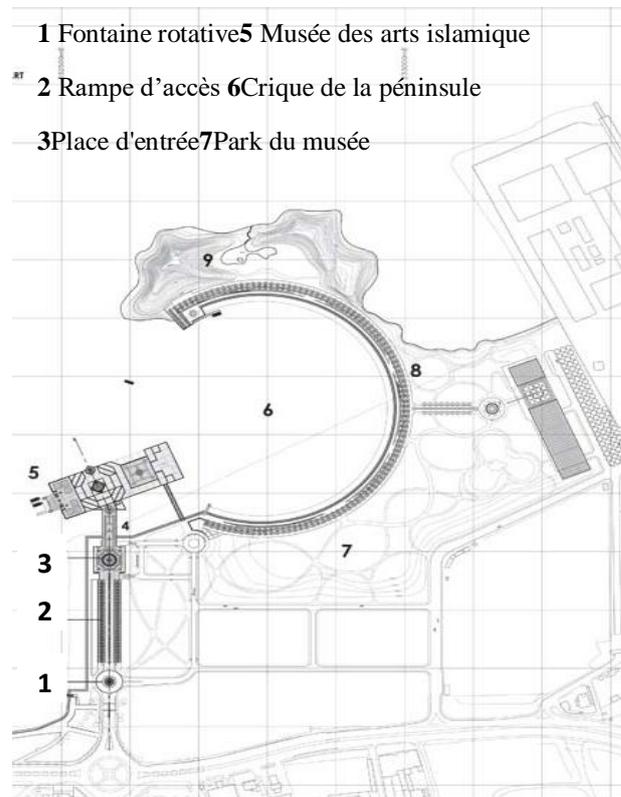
Plan de masse du projet, source : wikiparquitectura.com
